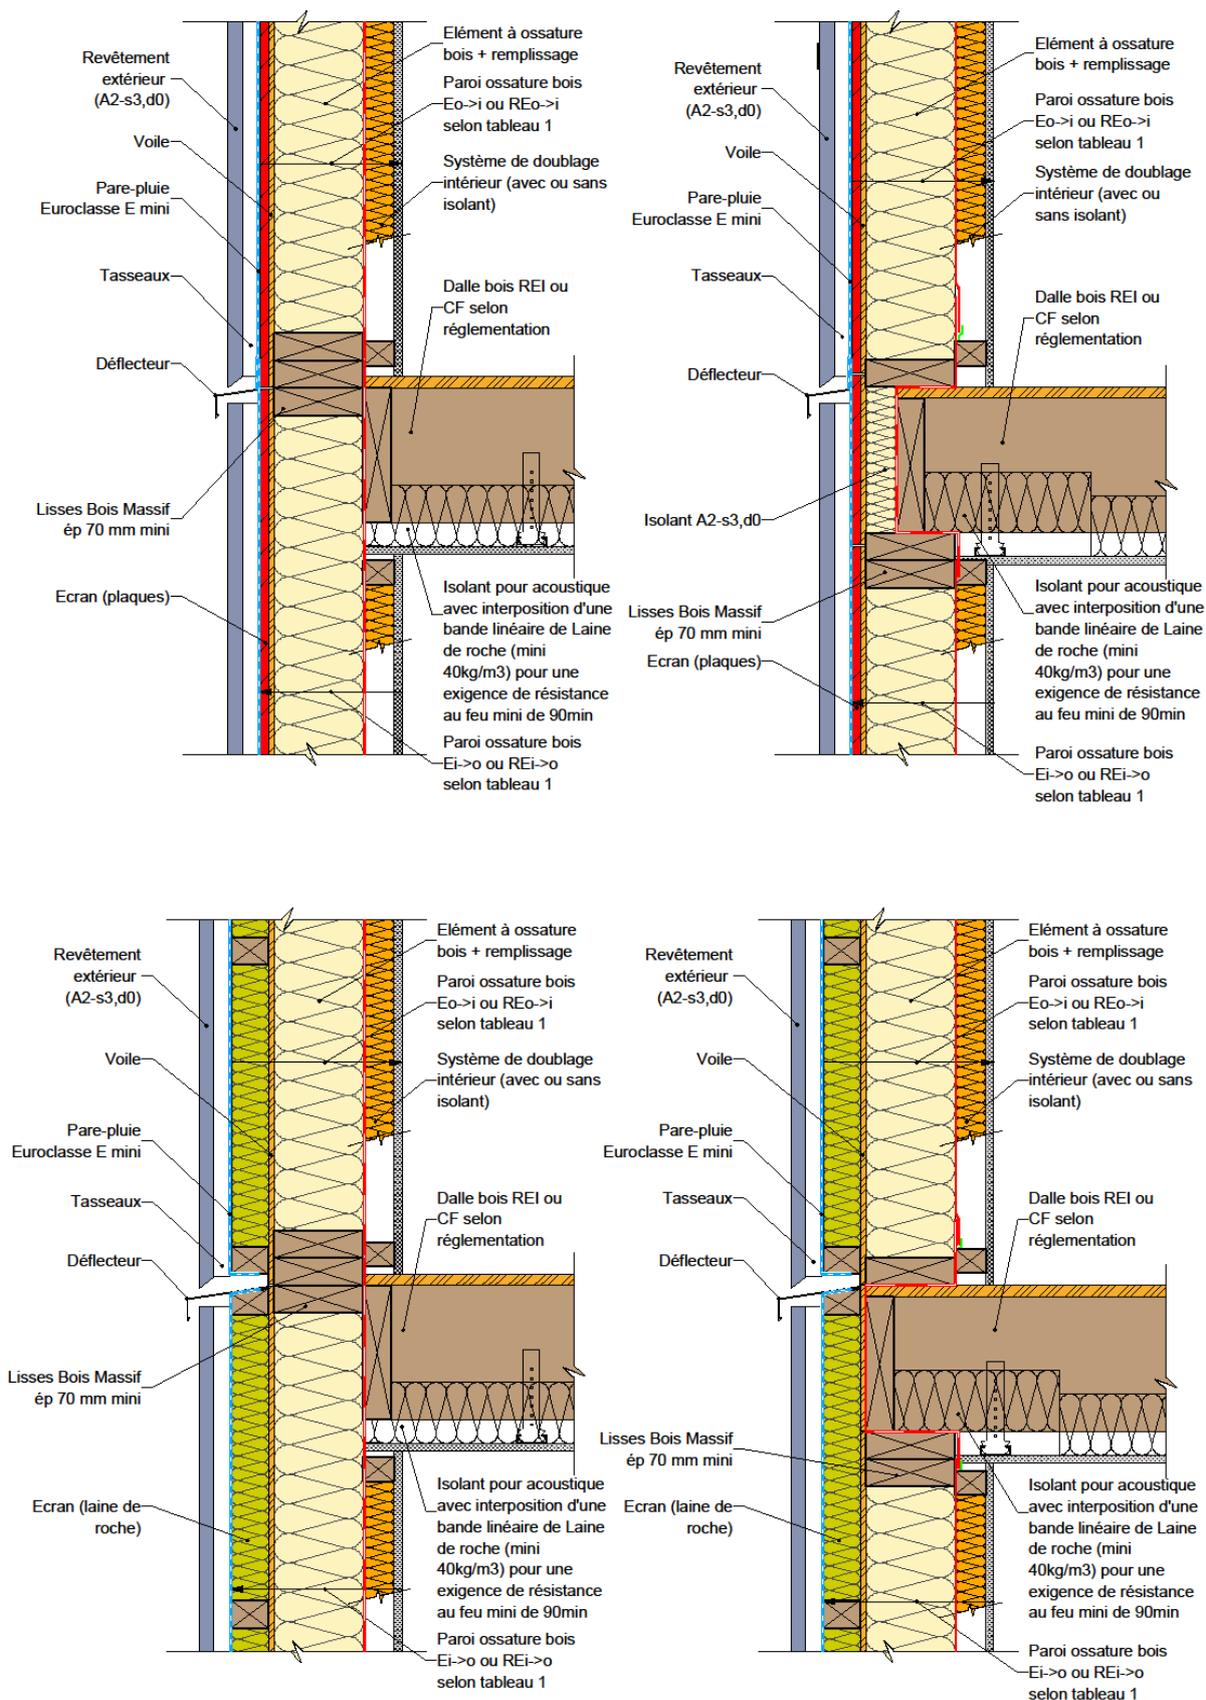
Façade/mur en ossature bois & plancher en ossature bois.
